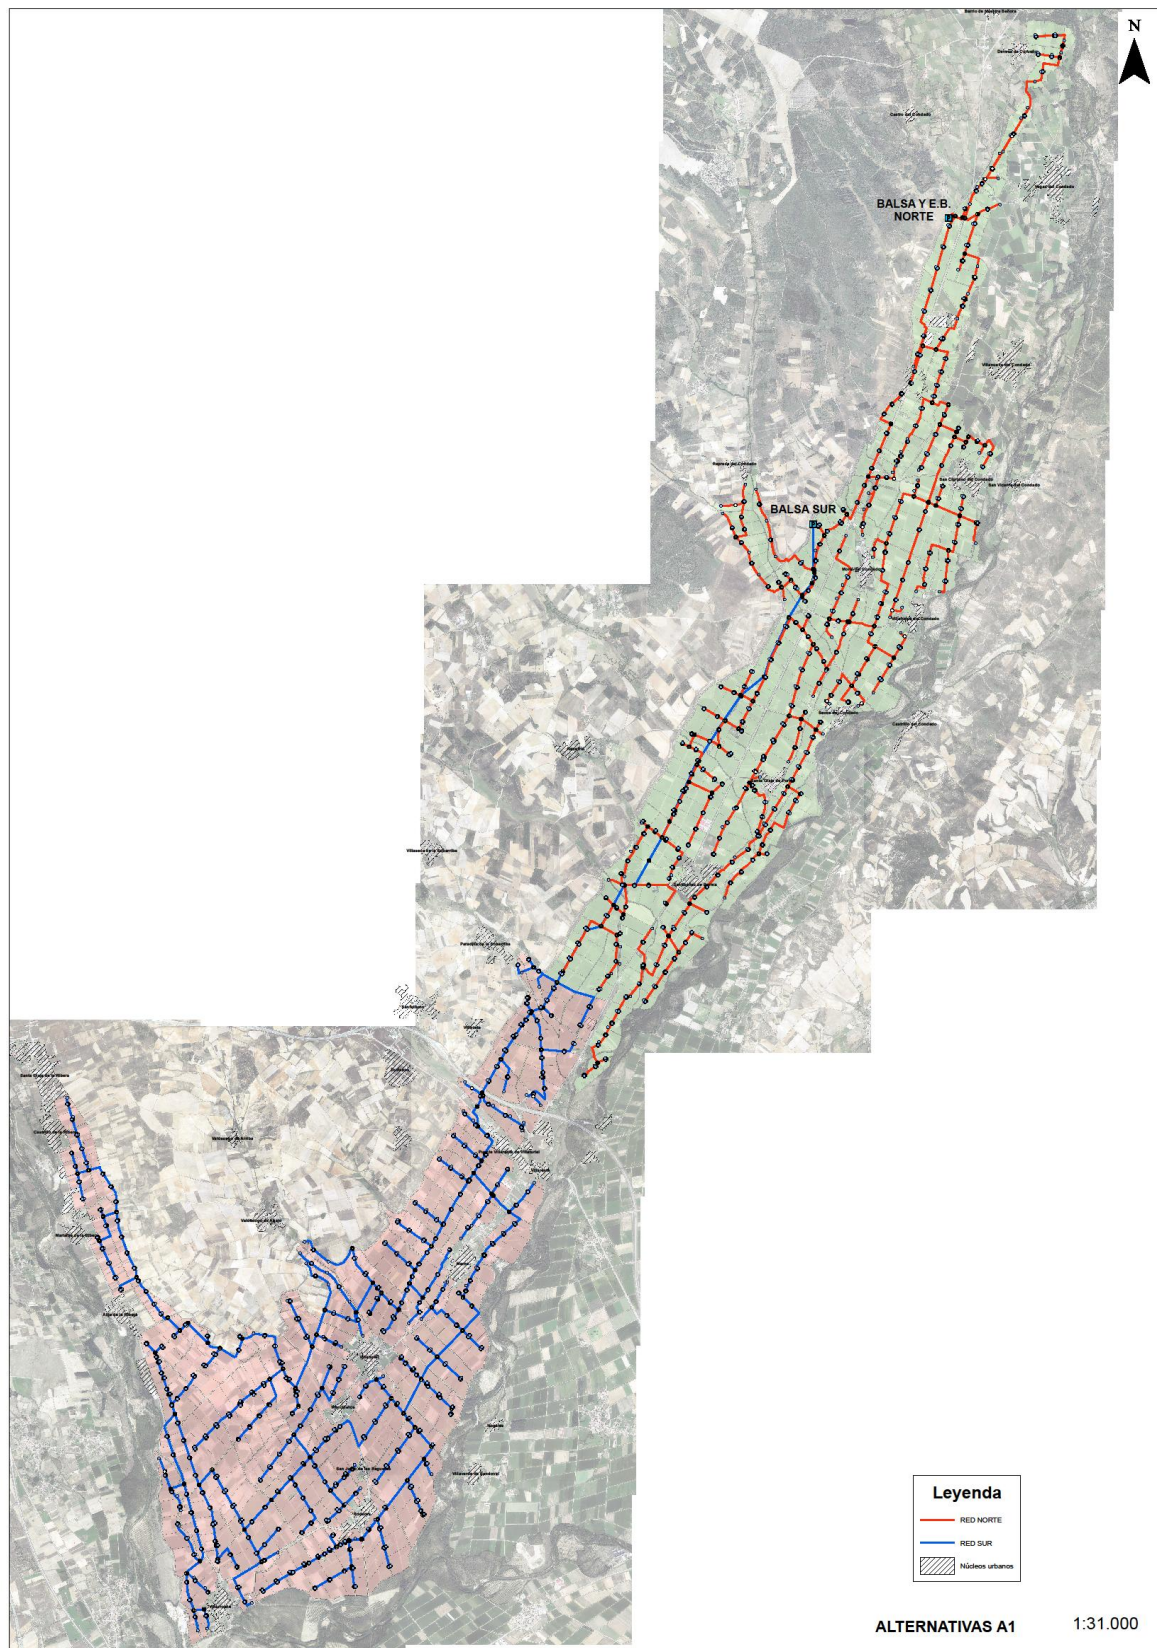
Ubicación de las infraestructuras en la Alternativa 1.
